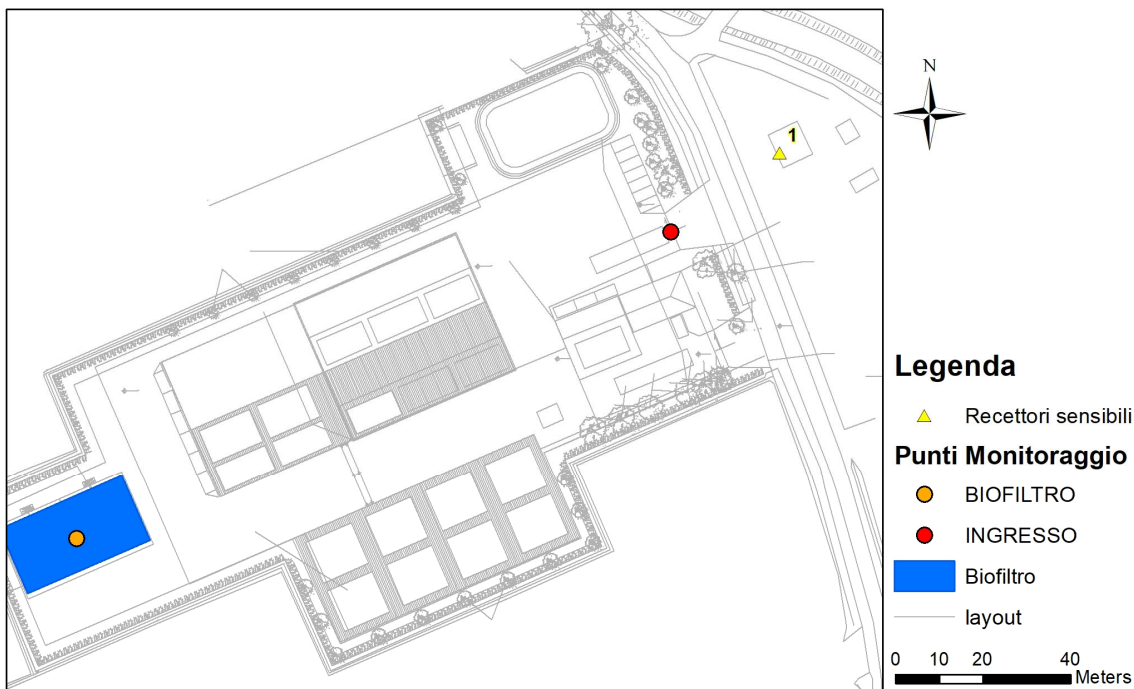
Estratto della planimetria di progetto con indicazione dei punti di monitoraggio olfattometrico.
